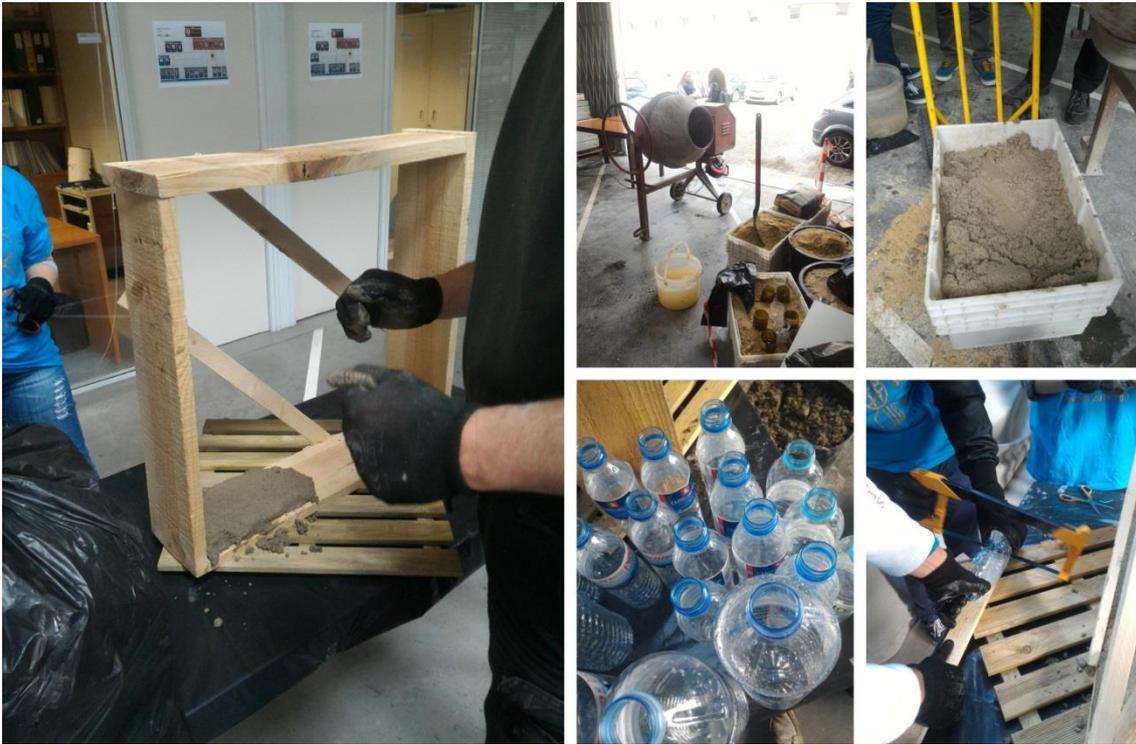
Ensaio e exemplificação constructiva de uma parede Earthship na FEUP
